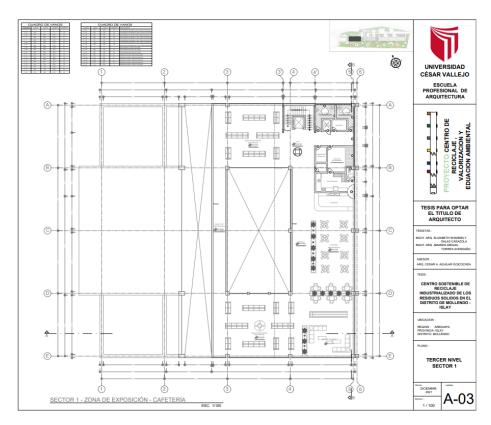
Planta de Distribución, Sector 1 – Tercer Nivel FUENTE: Elaboración Propia
